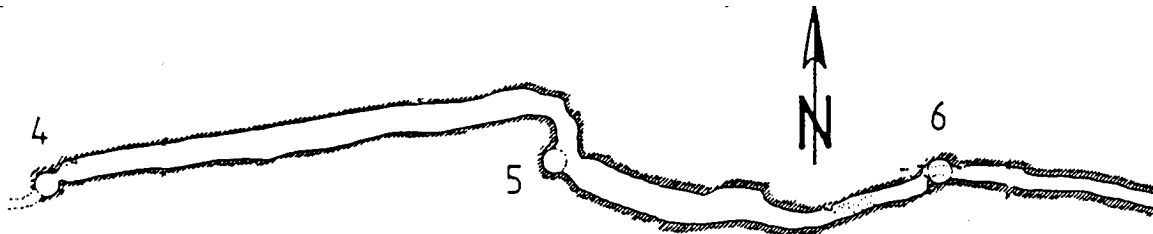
Lageplan 4-5-6 mit deutlich sichtbarem Fehler bei der Richtungsabsteckung
